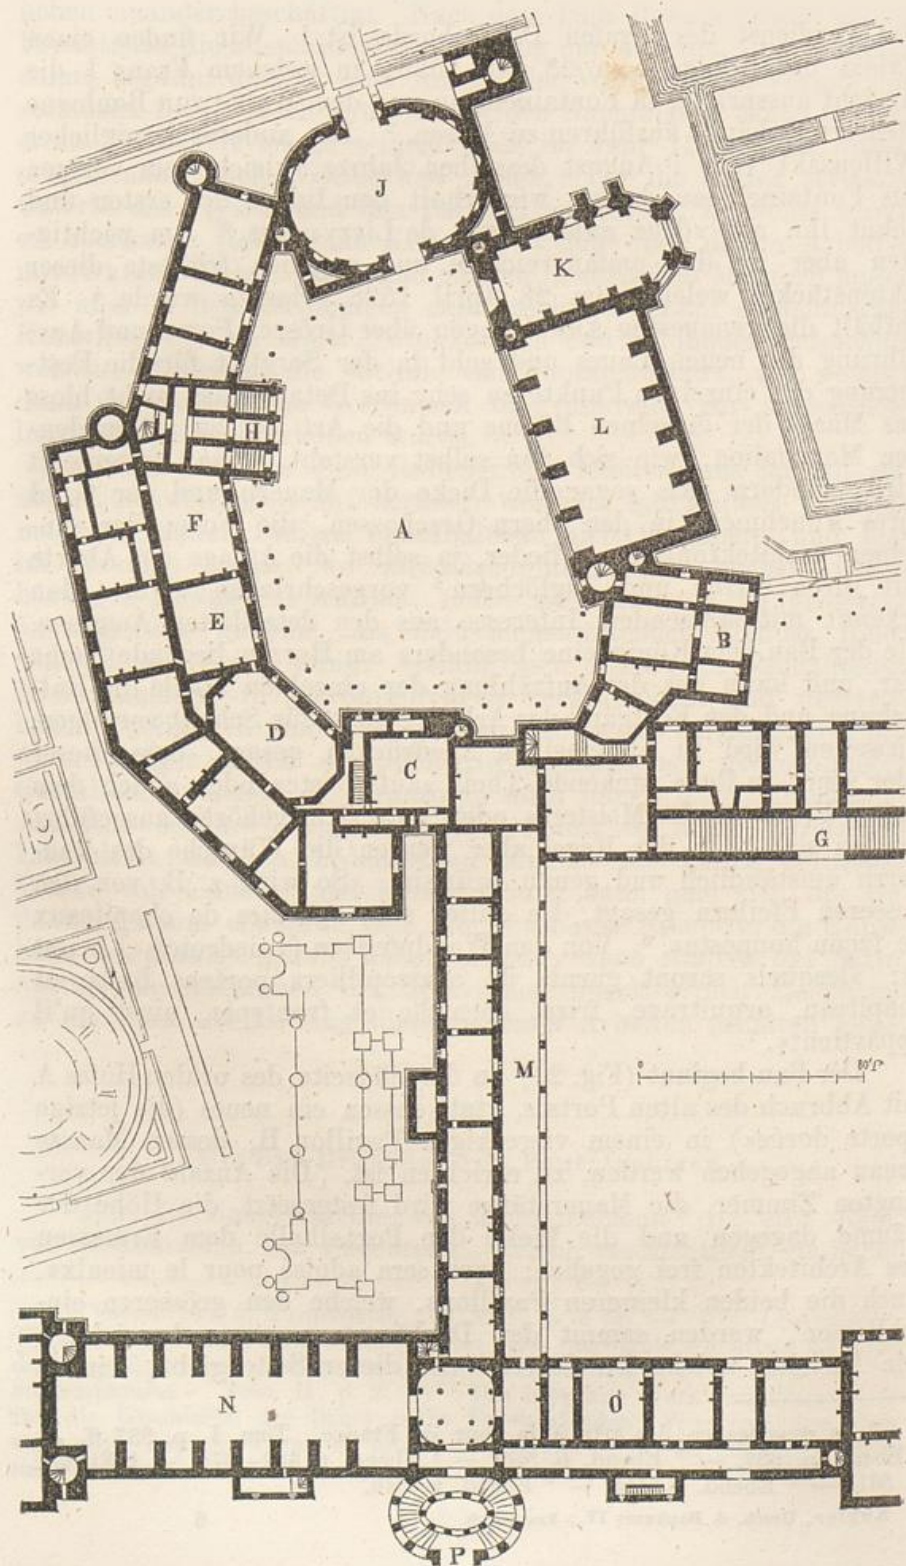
Fontainebleau. Grundriss der älteren Theile. (Du Cerceau.)
